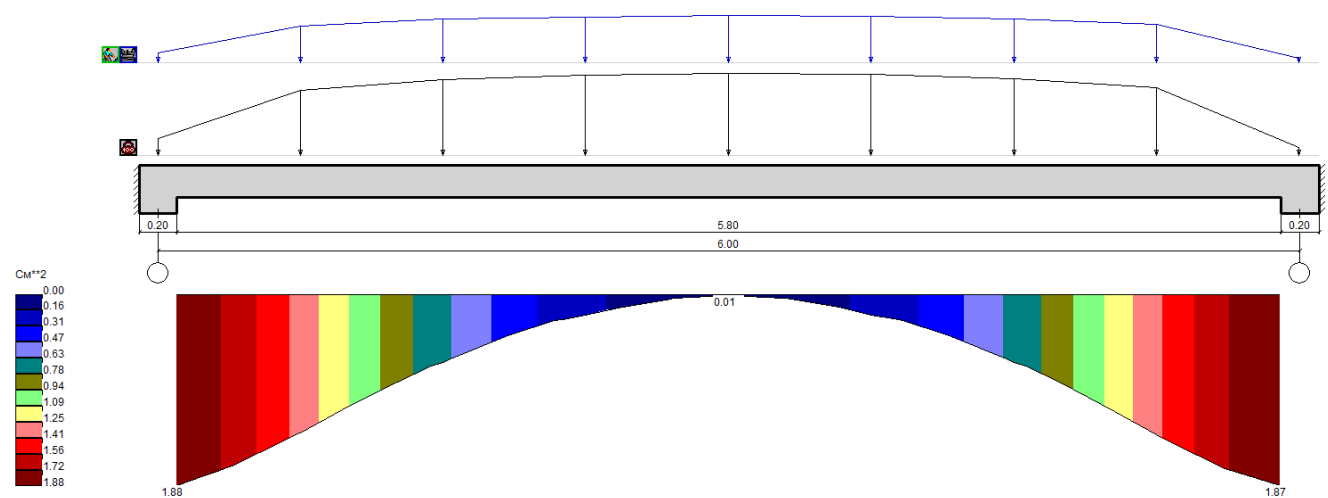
Поперечне армування балки перекриття на відм. 0.000
